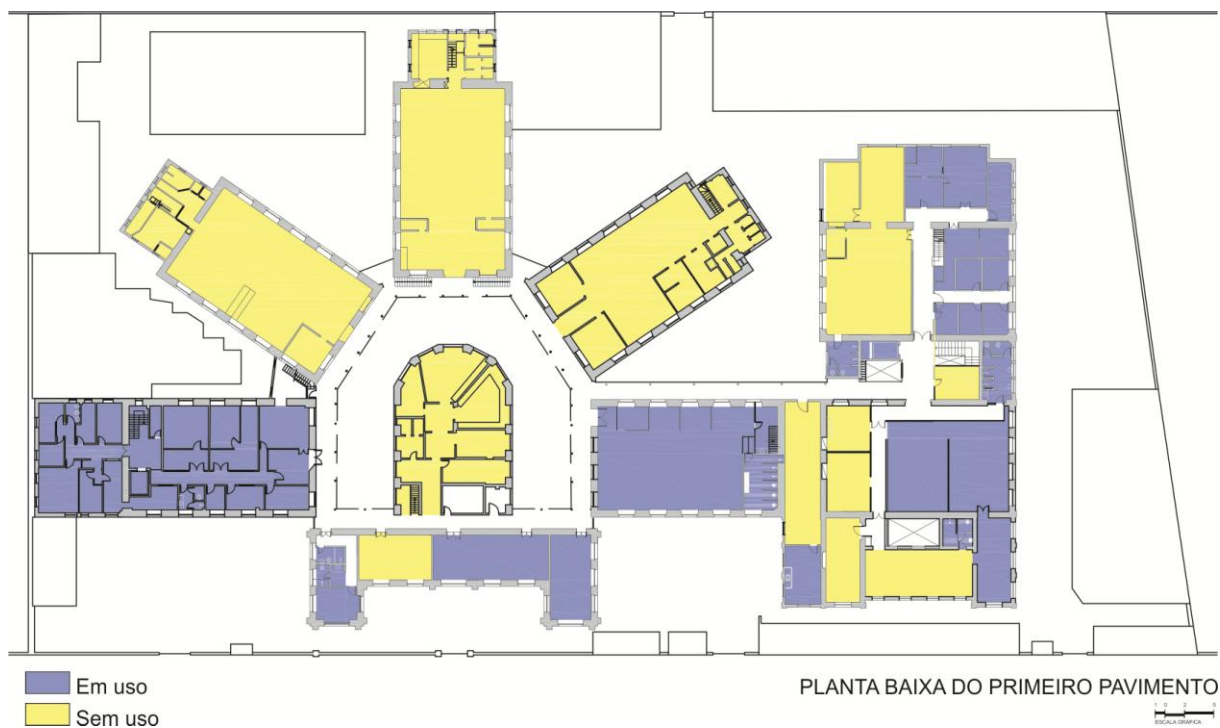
Planta Baixa do Primeiro Pavimento – Ocupação. Fonte: Plano Diretor, 2004.
